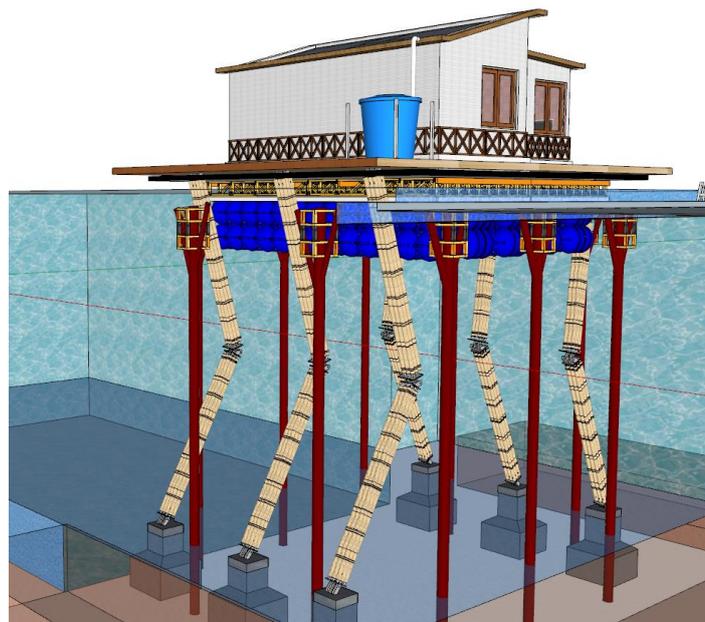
Render Exterior - Fachada Principal del Prototipo de vivienda resiliente
